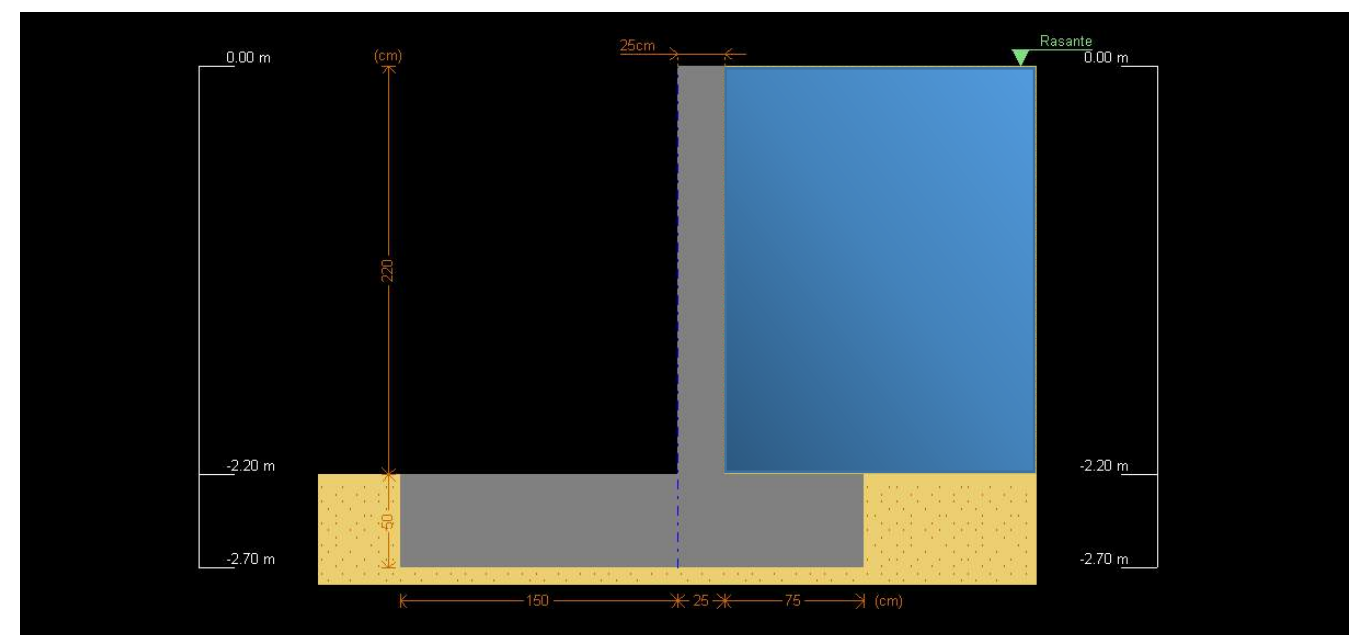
Geometría inicial del muro y situación de cálculo, con la columna de 2,20 metros de altura en el trasdós.
